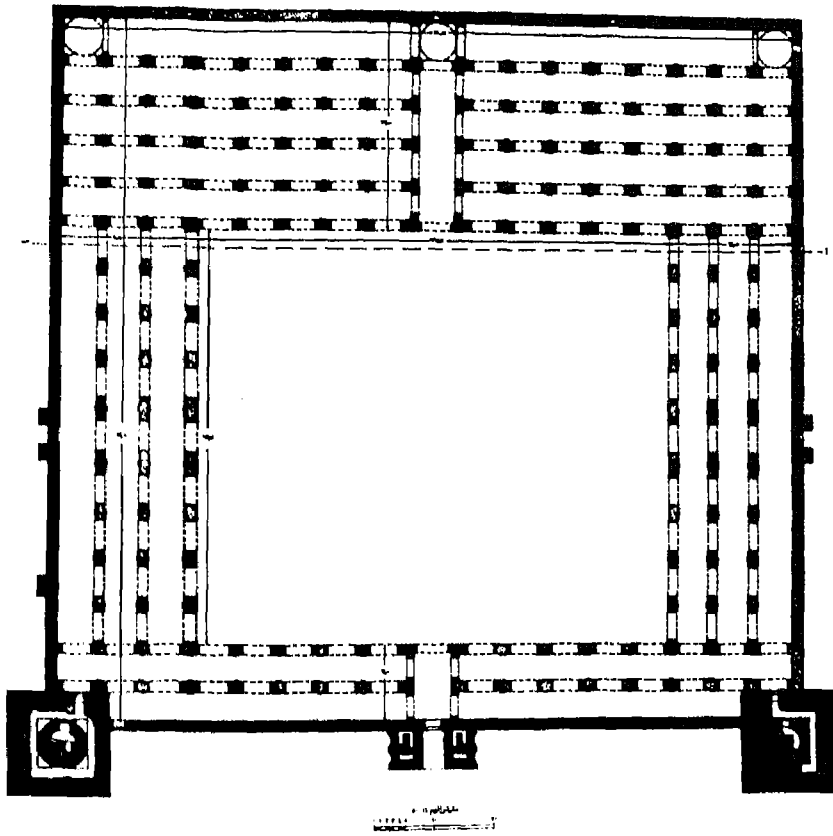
مسقط أفقى لجامع ابن طولون
